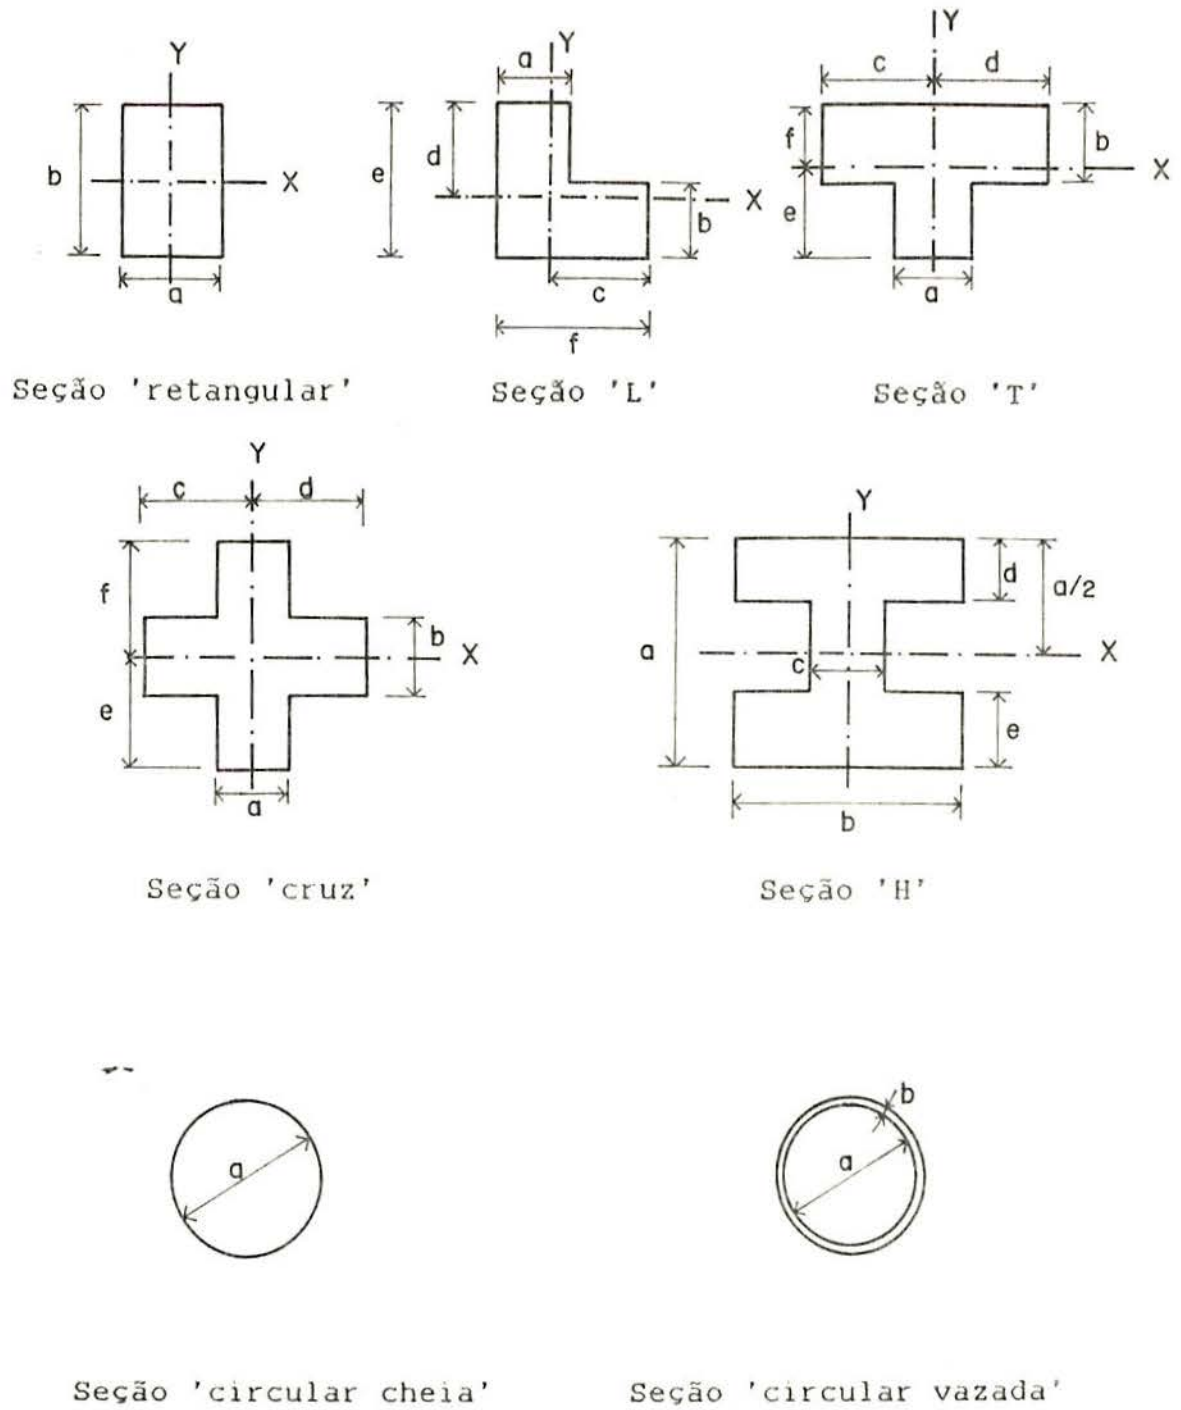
Classe de seções transversais para vigas e pilares e seus parâmetros de definição
